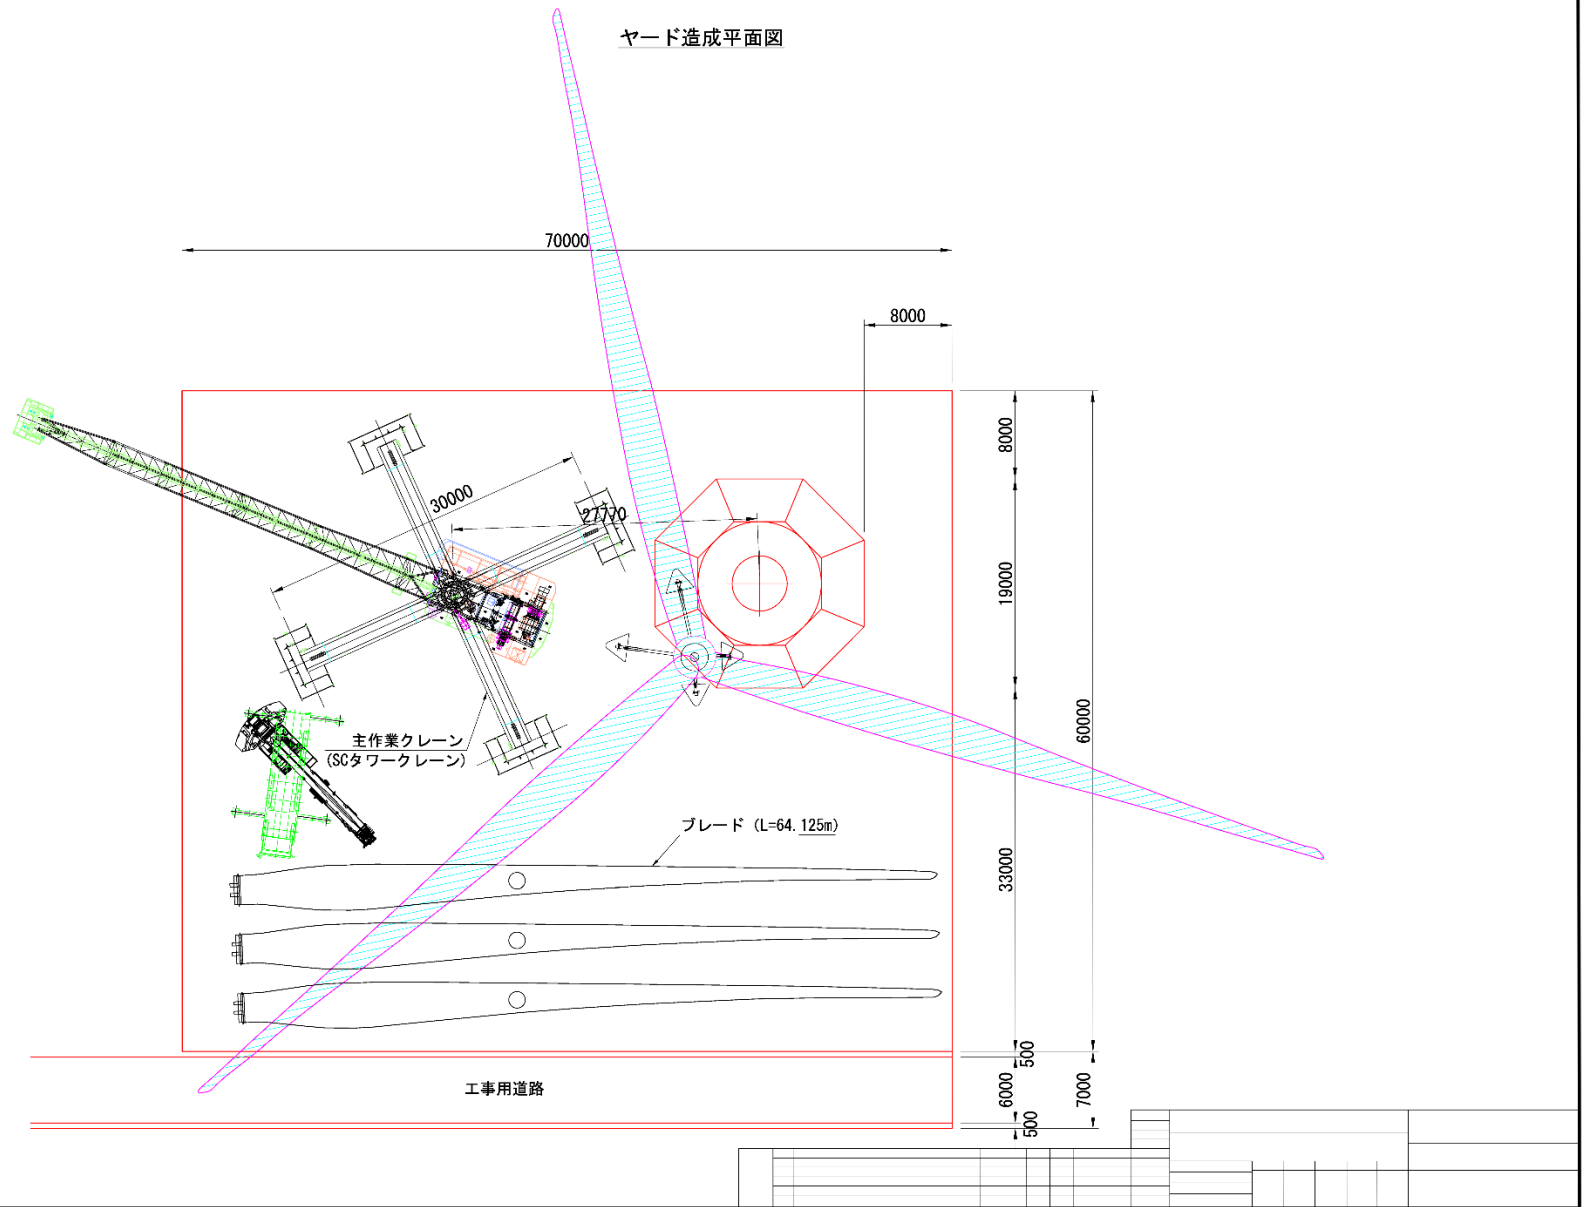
(1) 風力発電機ヤードの平面図 (例)
